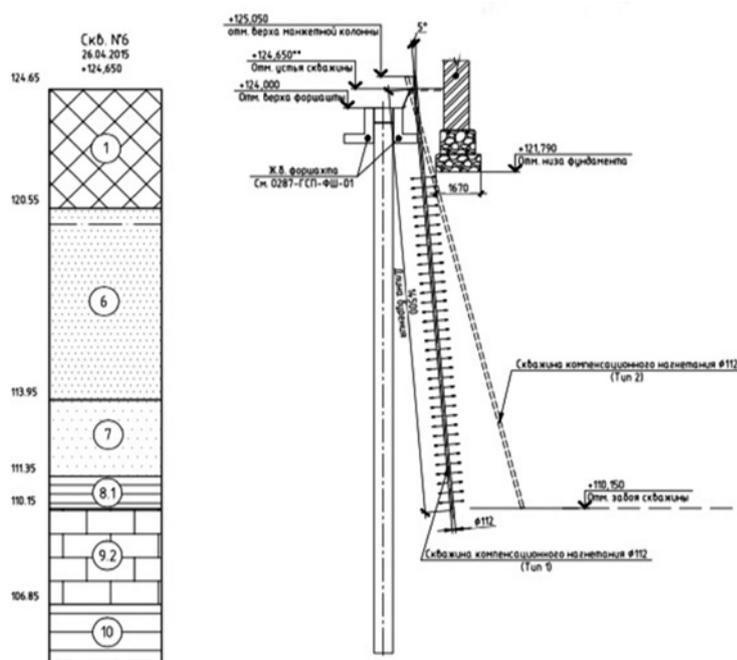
Схема выполнения работ по усилению грунтового основания фундаментов существующих зданий
